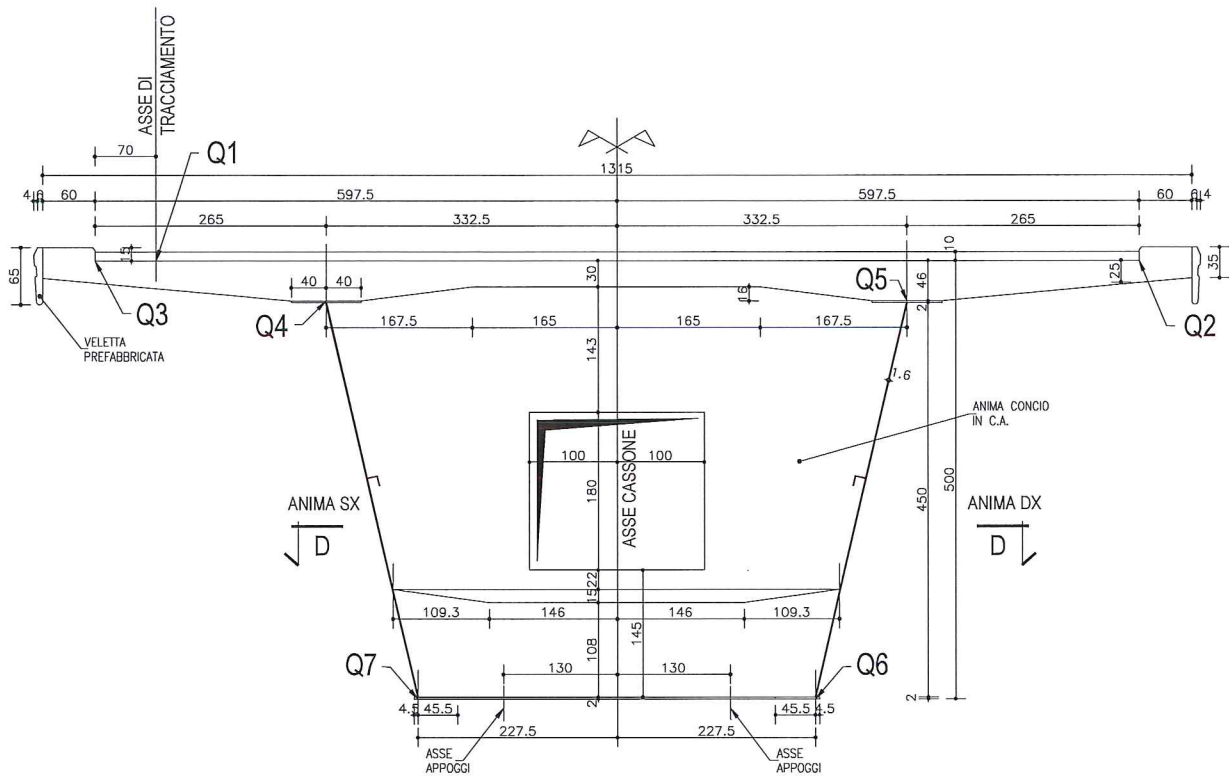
Concio 0 – Sezione trasversale impalcato di larghezza 13.15 m.
